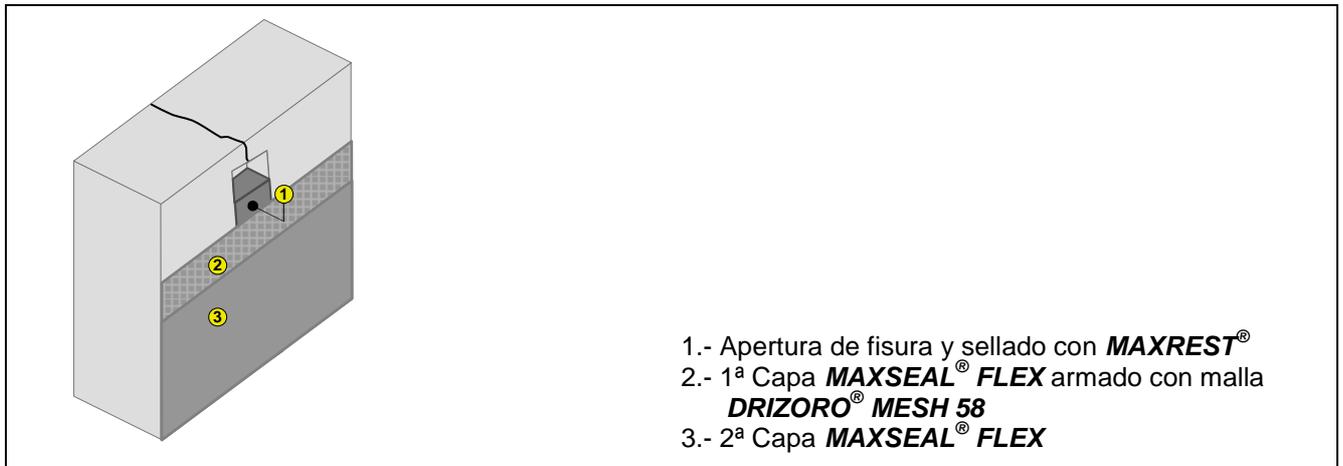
Tratamiento de juntas de hormigonado y fisuras
